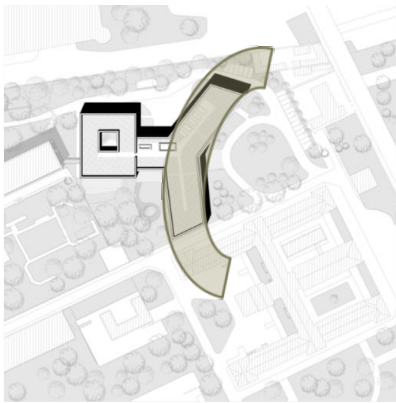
PLAN DE MASSE DE L'EHPAD
